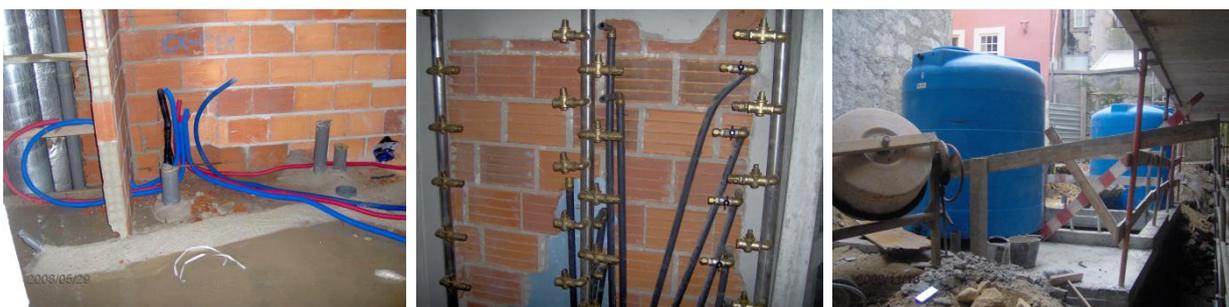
Fase de instalações (Setembro a Dezembro de 2008)
